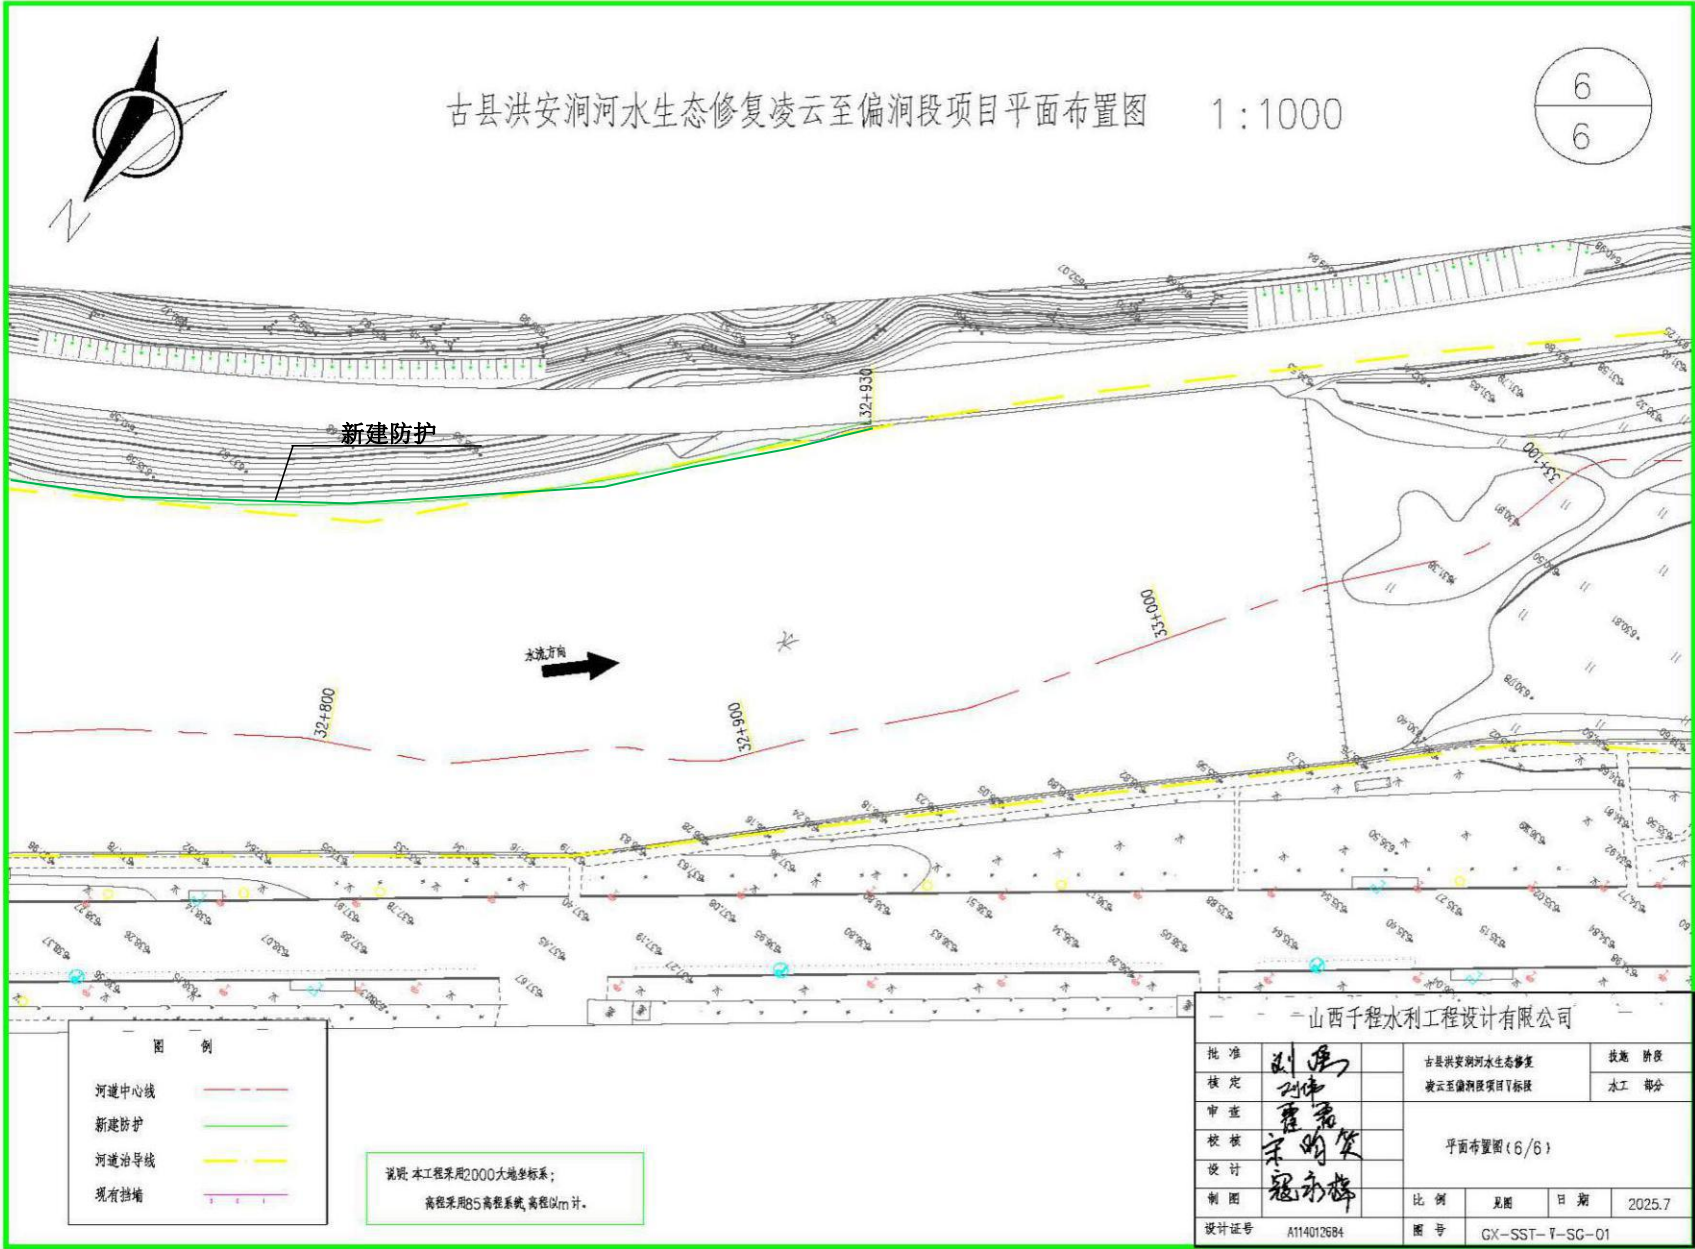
(19) 工程总平面布置图 (桩号 32+700-33+100)
